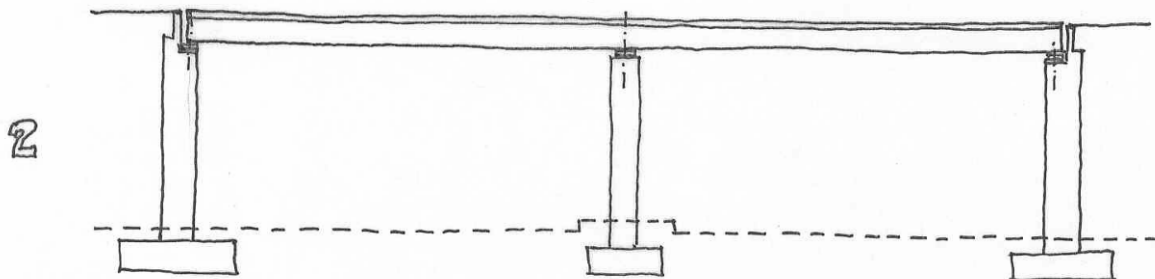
Ponti corti con spalle sismicamente attive, per le forze inerziali dell'impalcato.
